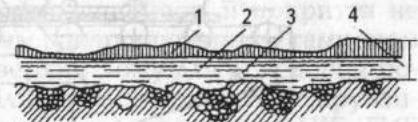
Схема облагороджування поверхні лакофарбового покриття:
